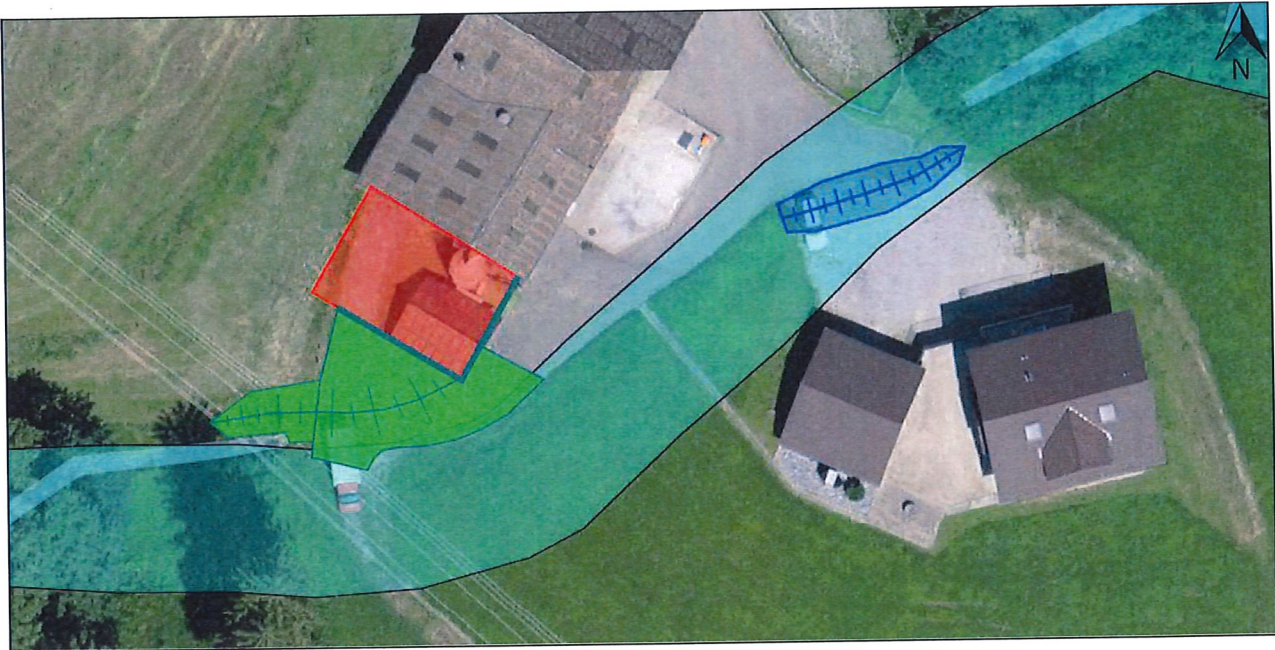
Vorgeschlagene Objektschutzmassnahmen am neuen Stall (grün) und dem Wohnhaus (blau) (rot: Neubau Ziegenstall, türkis: Gewässerraum)
